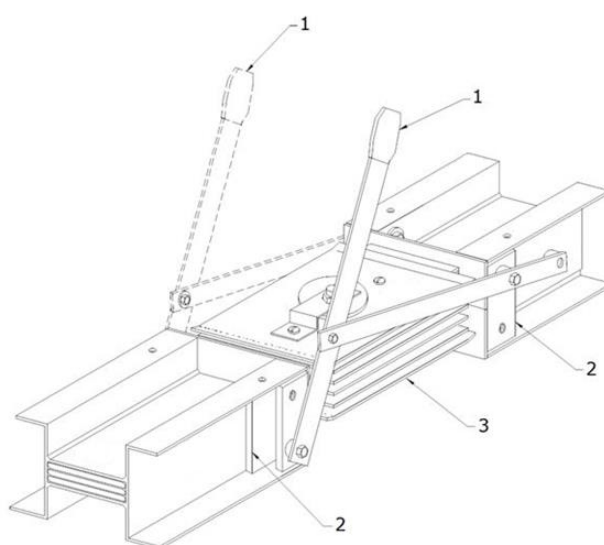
Соединение секций шинпровода: 1 – приспособление для стягивания секций; 2 – соединяемые секции; 3 – стыковочный (соединительный) блок
